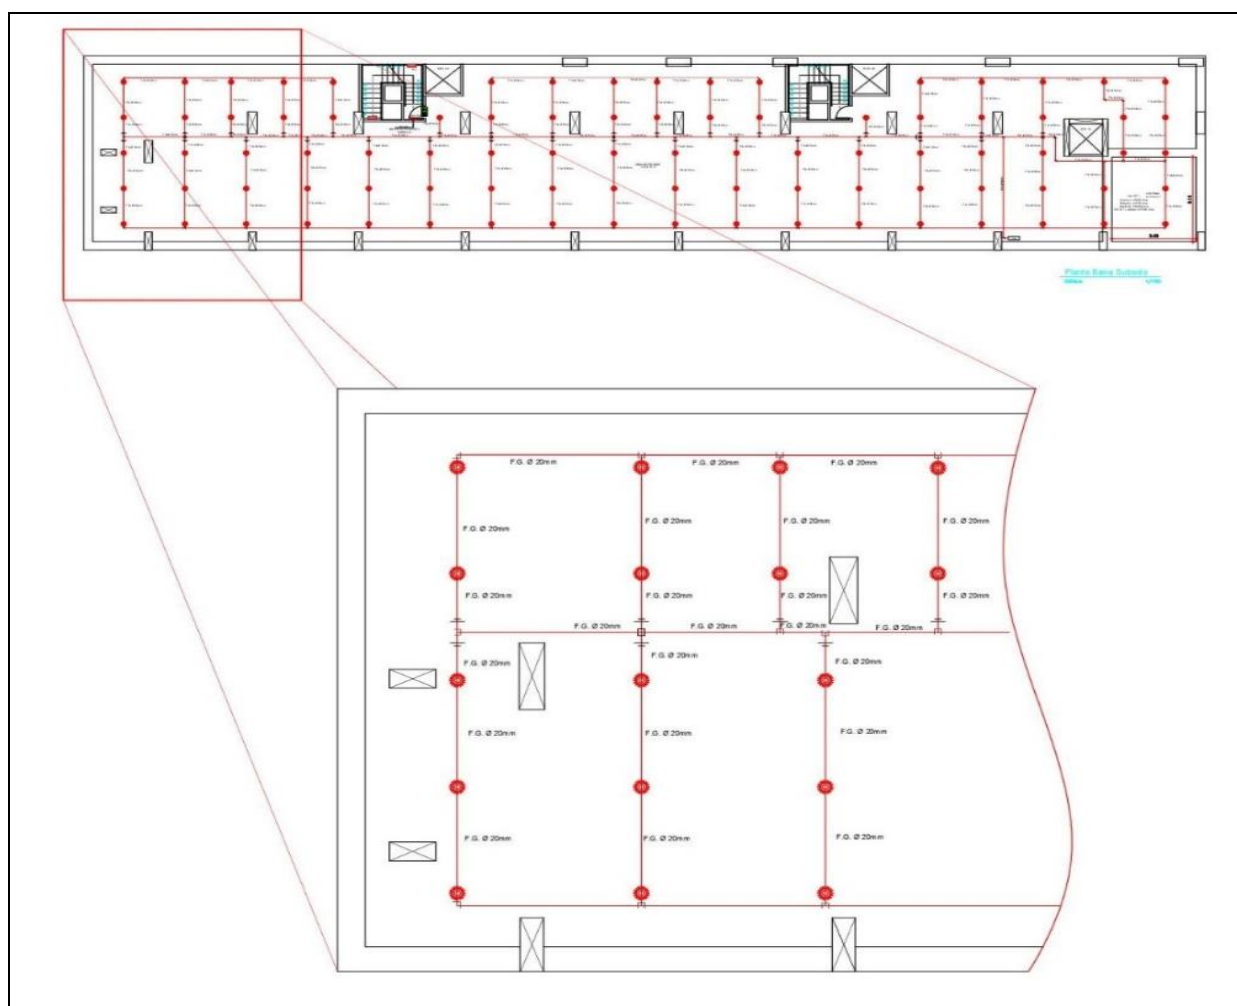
Corte da planta de disposição dos chuveiros automáticos do projeto original
